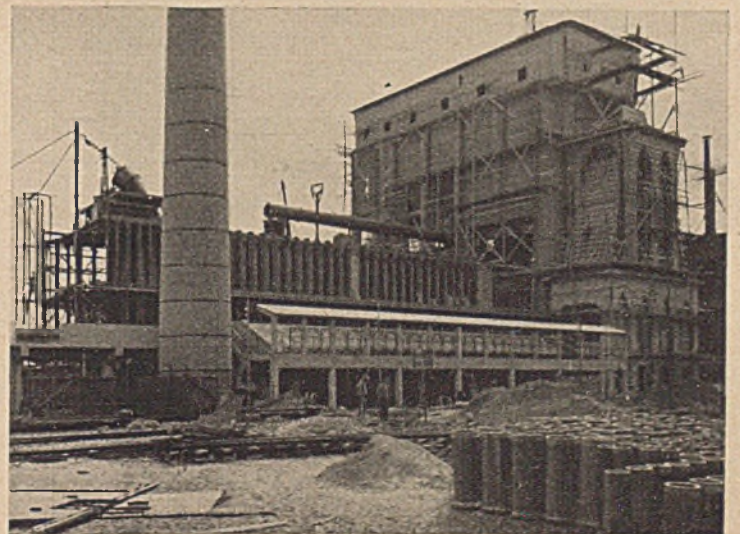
Kokslöschwagenbahn mit Abwurframpe.
